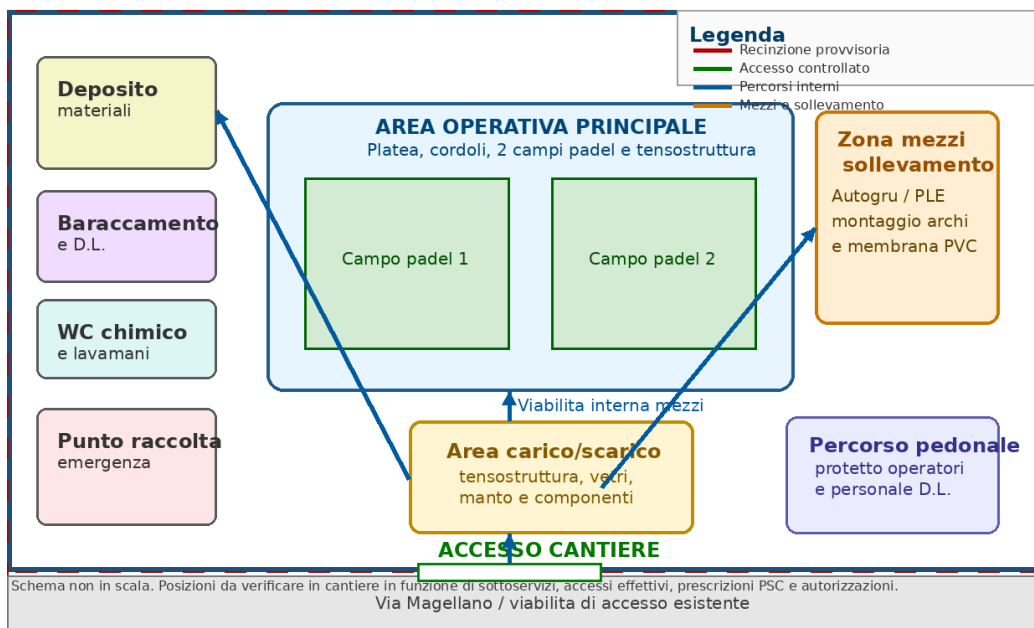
Schema funzionale del layout di cantiere. Schema indicativo e non in scala; da verificare e aggiornare in sede esecutiva dal CSE.
